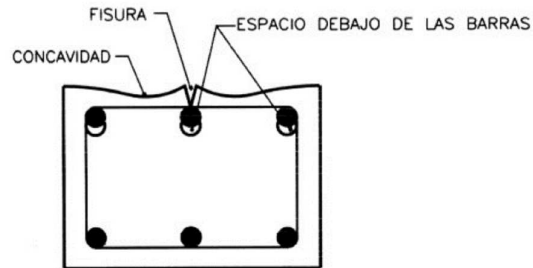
Fisura en armadura longitudinal (Fuente, M. Muños Hidalgo)
